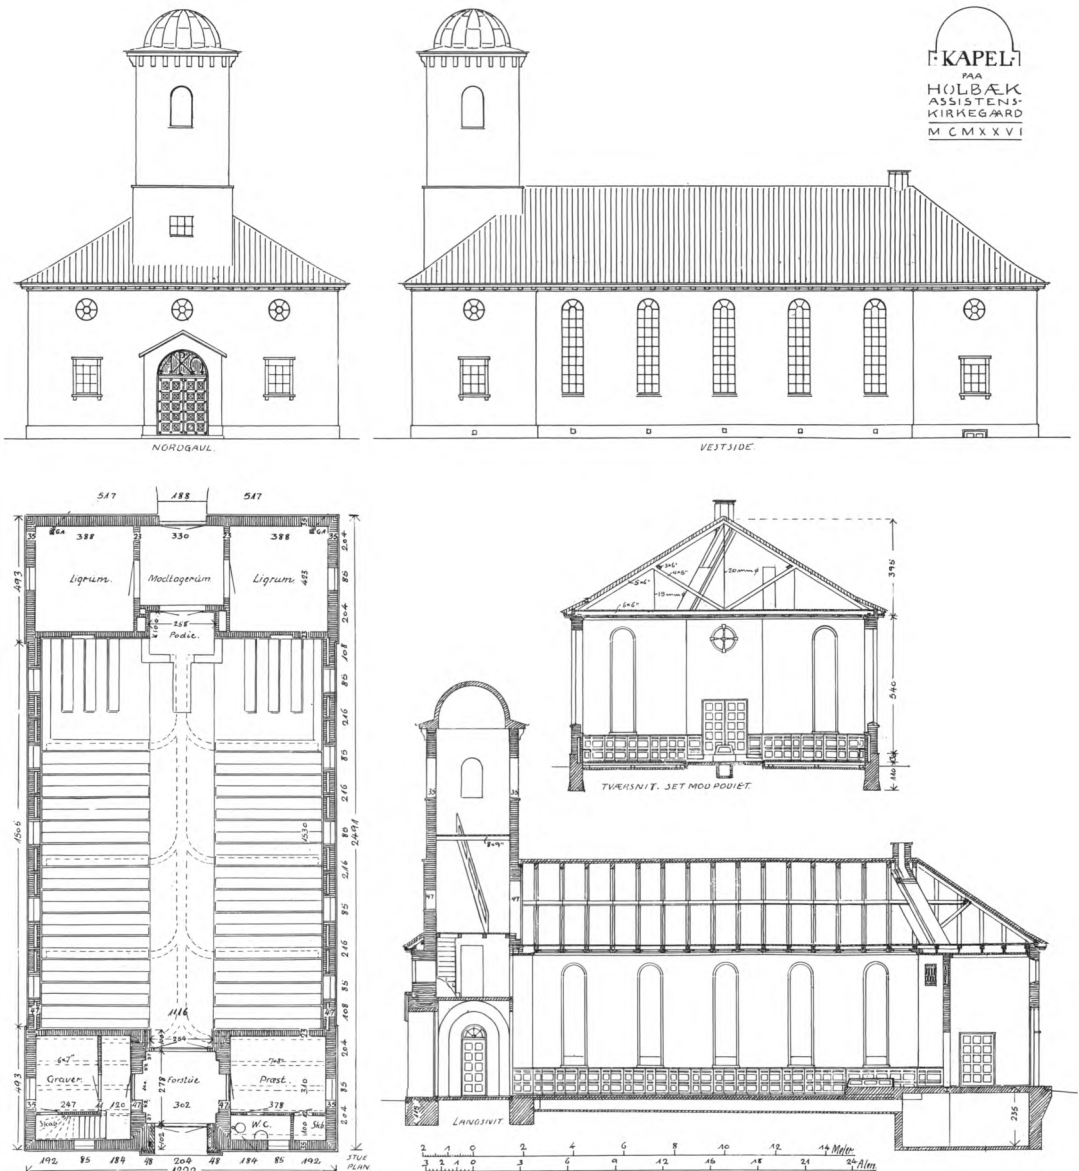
Østre kapel. Plan, tvær- og længdesnit samt nord- og vestfacade. 1:300. Tegnet af Marius Pedersen 1926. NM3. - East chapel. Plan, cross-section, longitudinal section north and west elevation.
